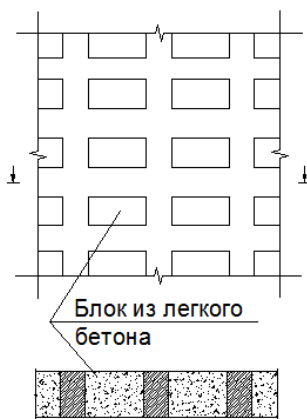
Кессонное перекрытие с блоками из легкого бетона в кессонах
